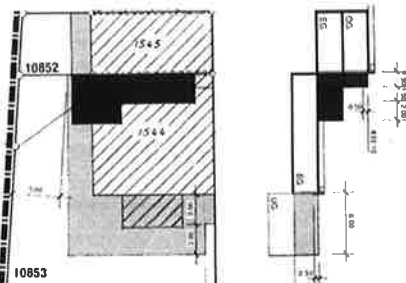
Ueberbaurecht (in Grundriss und Schnitt)
